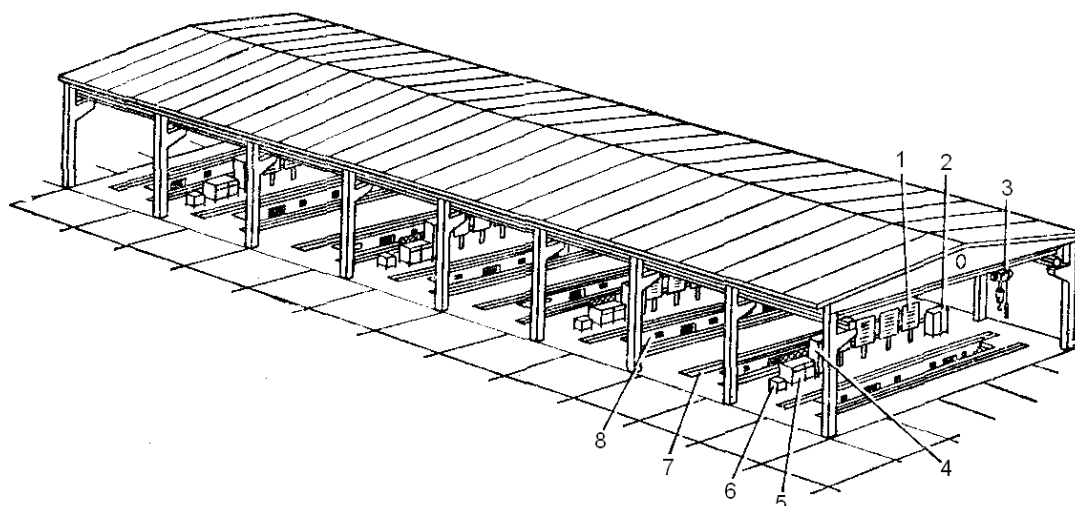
Площадка ежедневного технического обслуживания БТТ:
